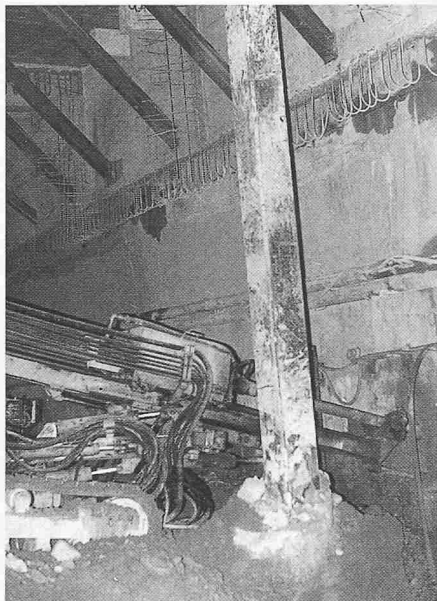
Einbau der Ankerlage unter dem Deckel. Oben sichtbar sind die Schrägspriessse vom Deckel auf die vorgängig betonierete Wandschürze. Im Vordergrund einer der 40 Bohrpfähle mit Stahlprofil.
